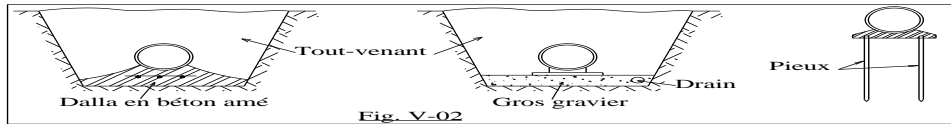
Pose de conduite dans mauvais terrain.
